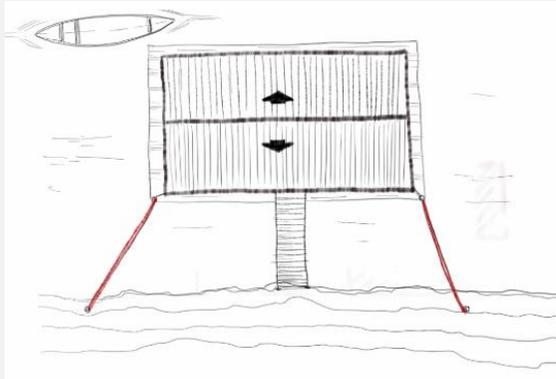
Esquema en planta de anclaje de la base de la vivienda flotante
